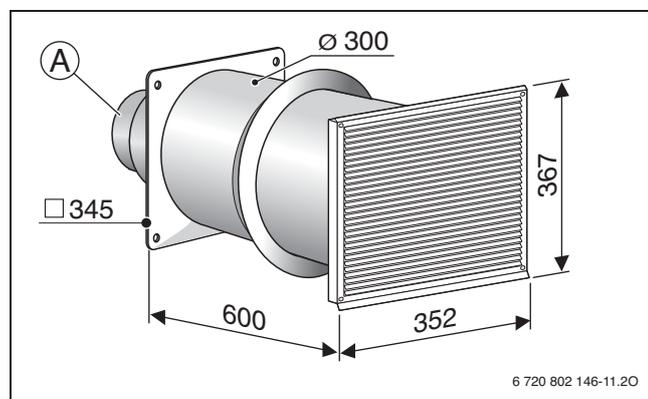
Dimensioni passaggio attraverso la parete WG 160-2 (dimensioni in mm)
